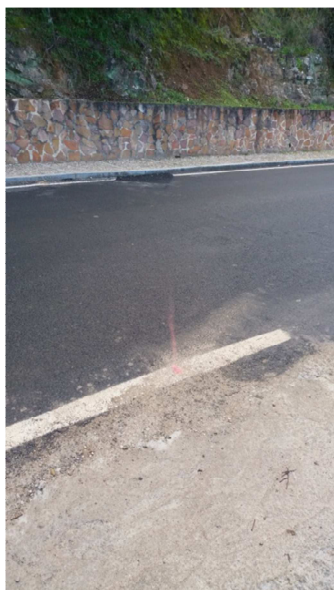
Tramo enterrado bajo calzada. Cruce de carretera.
